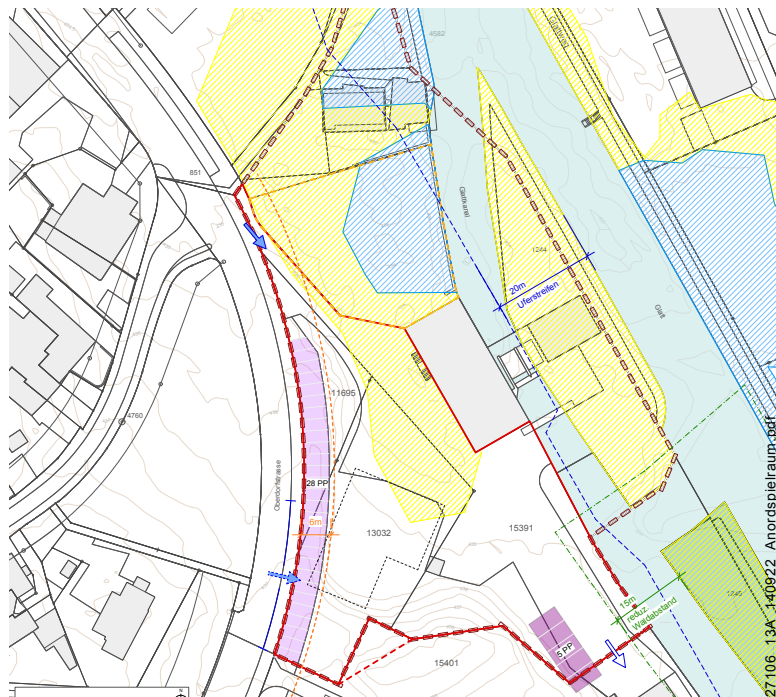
Plan Projektperimeter mit Anordnungsspielraum
